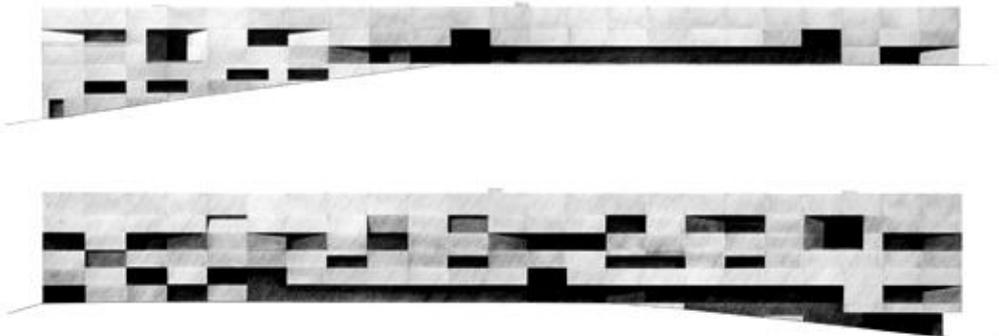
DESENHO DAS ABERTURAS DA FACHADA
